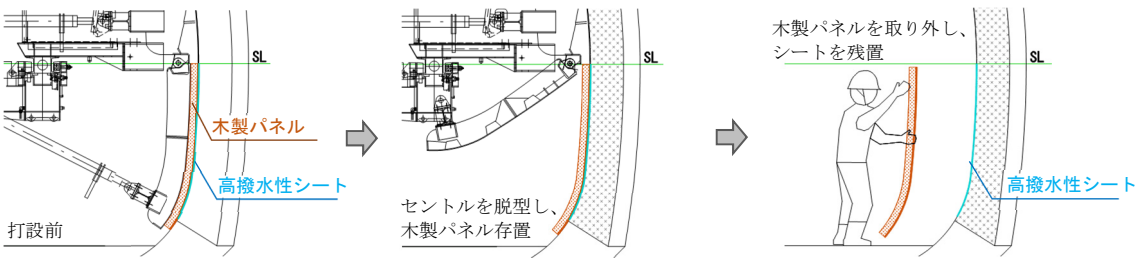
SL 下部に特殊長期湿潤養生適用の施工方針
